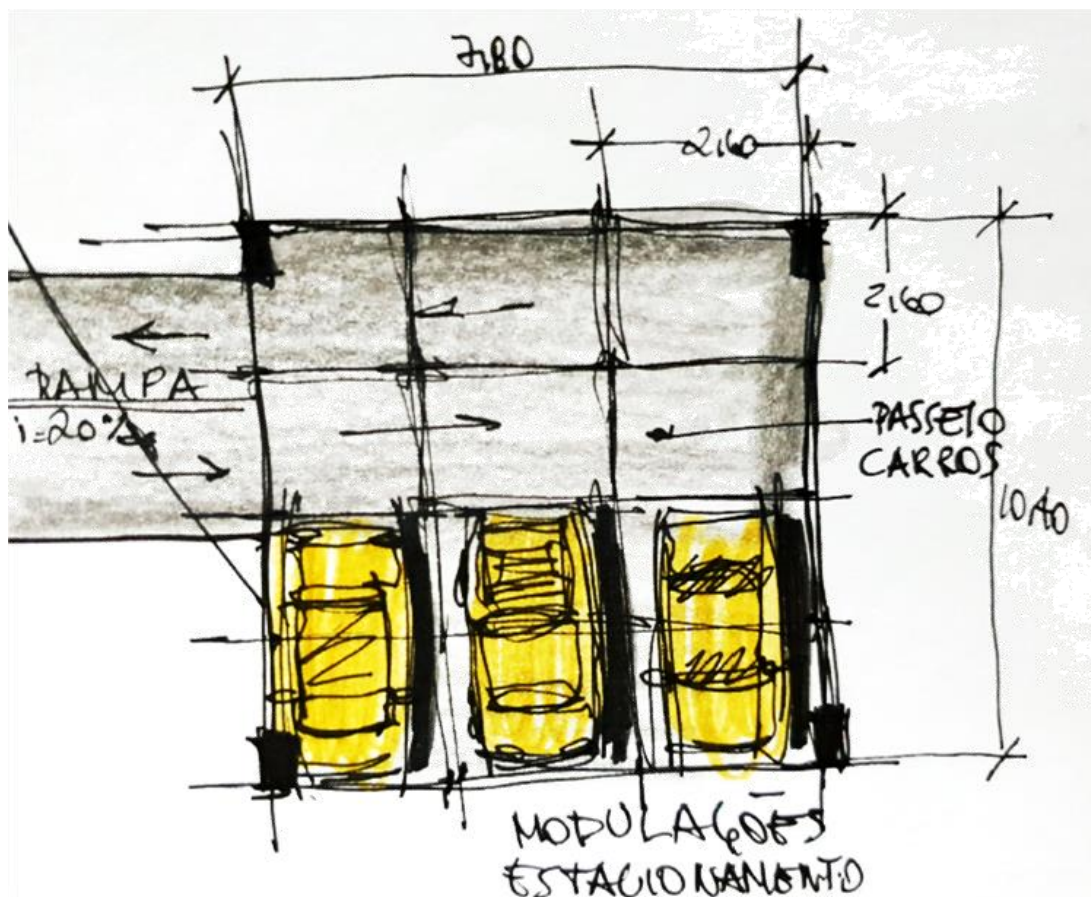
Modulação da estrutura pré-fabricada a partir do estacionamento subterrâneo. Croqui feito a mão
